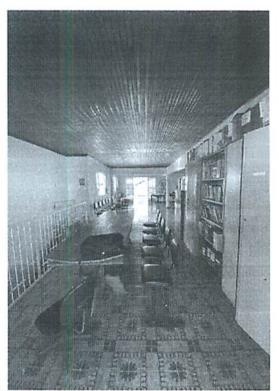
e 20: Piso cerâmico em ótimo estado de conservação, parapeito de alumínio se encontra em excelente estado de manutenção.
